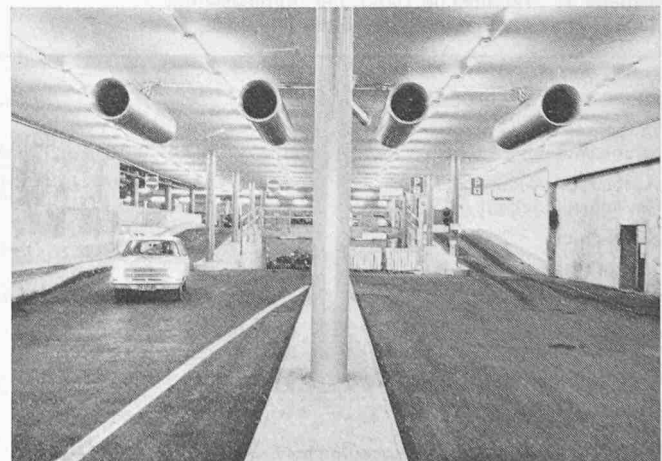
Treibstrahl-Vorhang in der Zufahrtsrampe des neuen Parkhauses unter dem SBB-Bahnhof Baden
